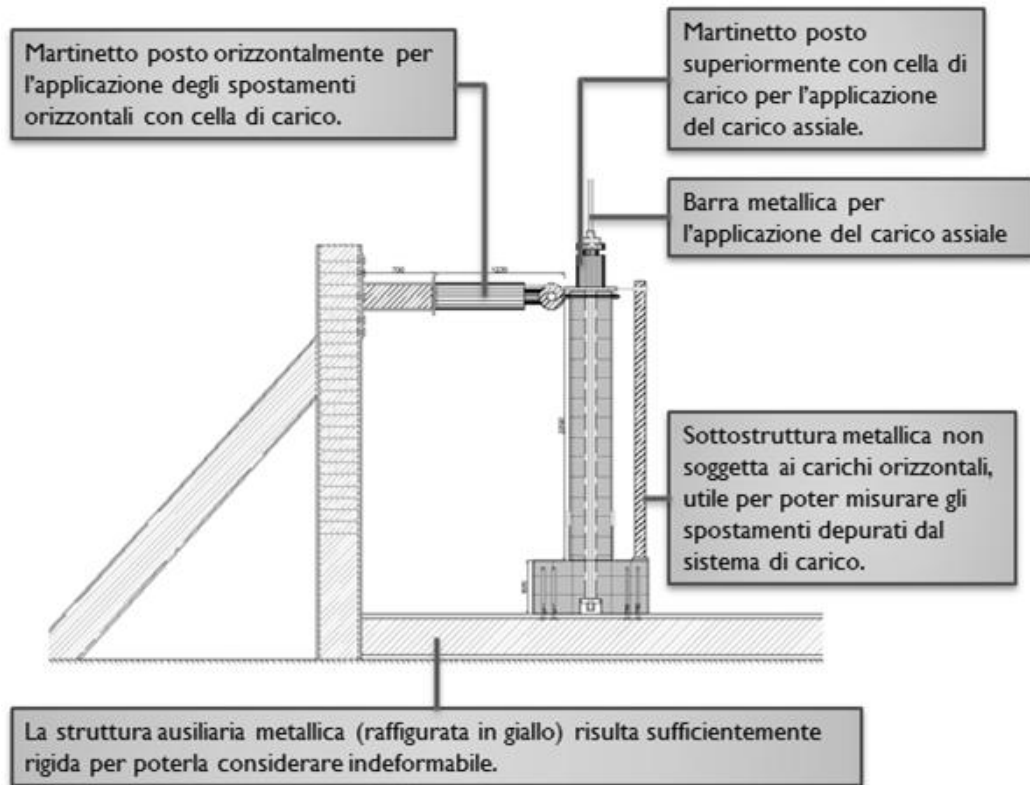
Schematizzazione del setup di prova. In evidenza la fondazione fissata alla trave in acciaio e il martinetto orizzontale
